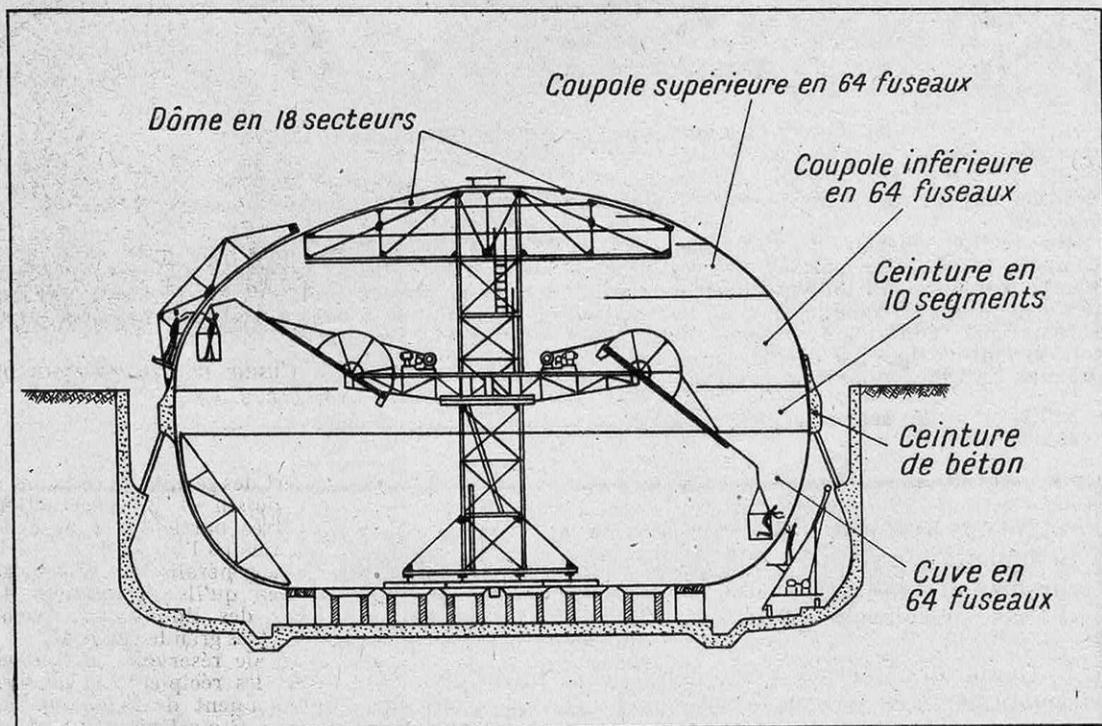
SCHEMA DES DISPOSITIFS DE SOUDAGE POUR LE MONTAGE D'UN RÉSERVOIR CAQUOT DE 3 500 m³
